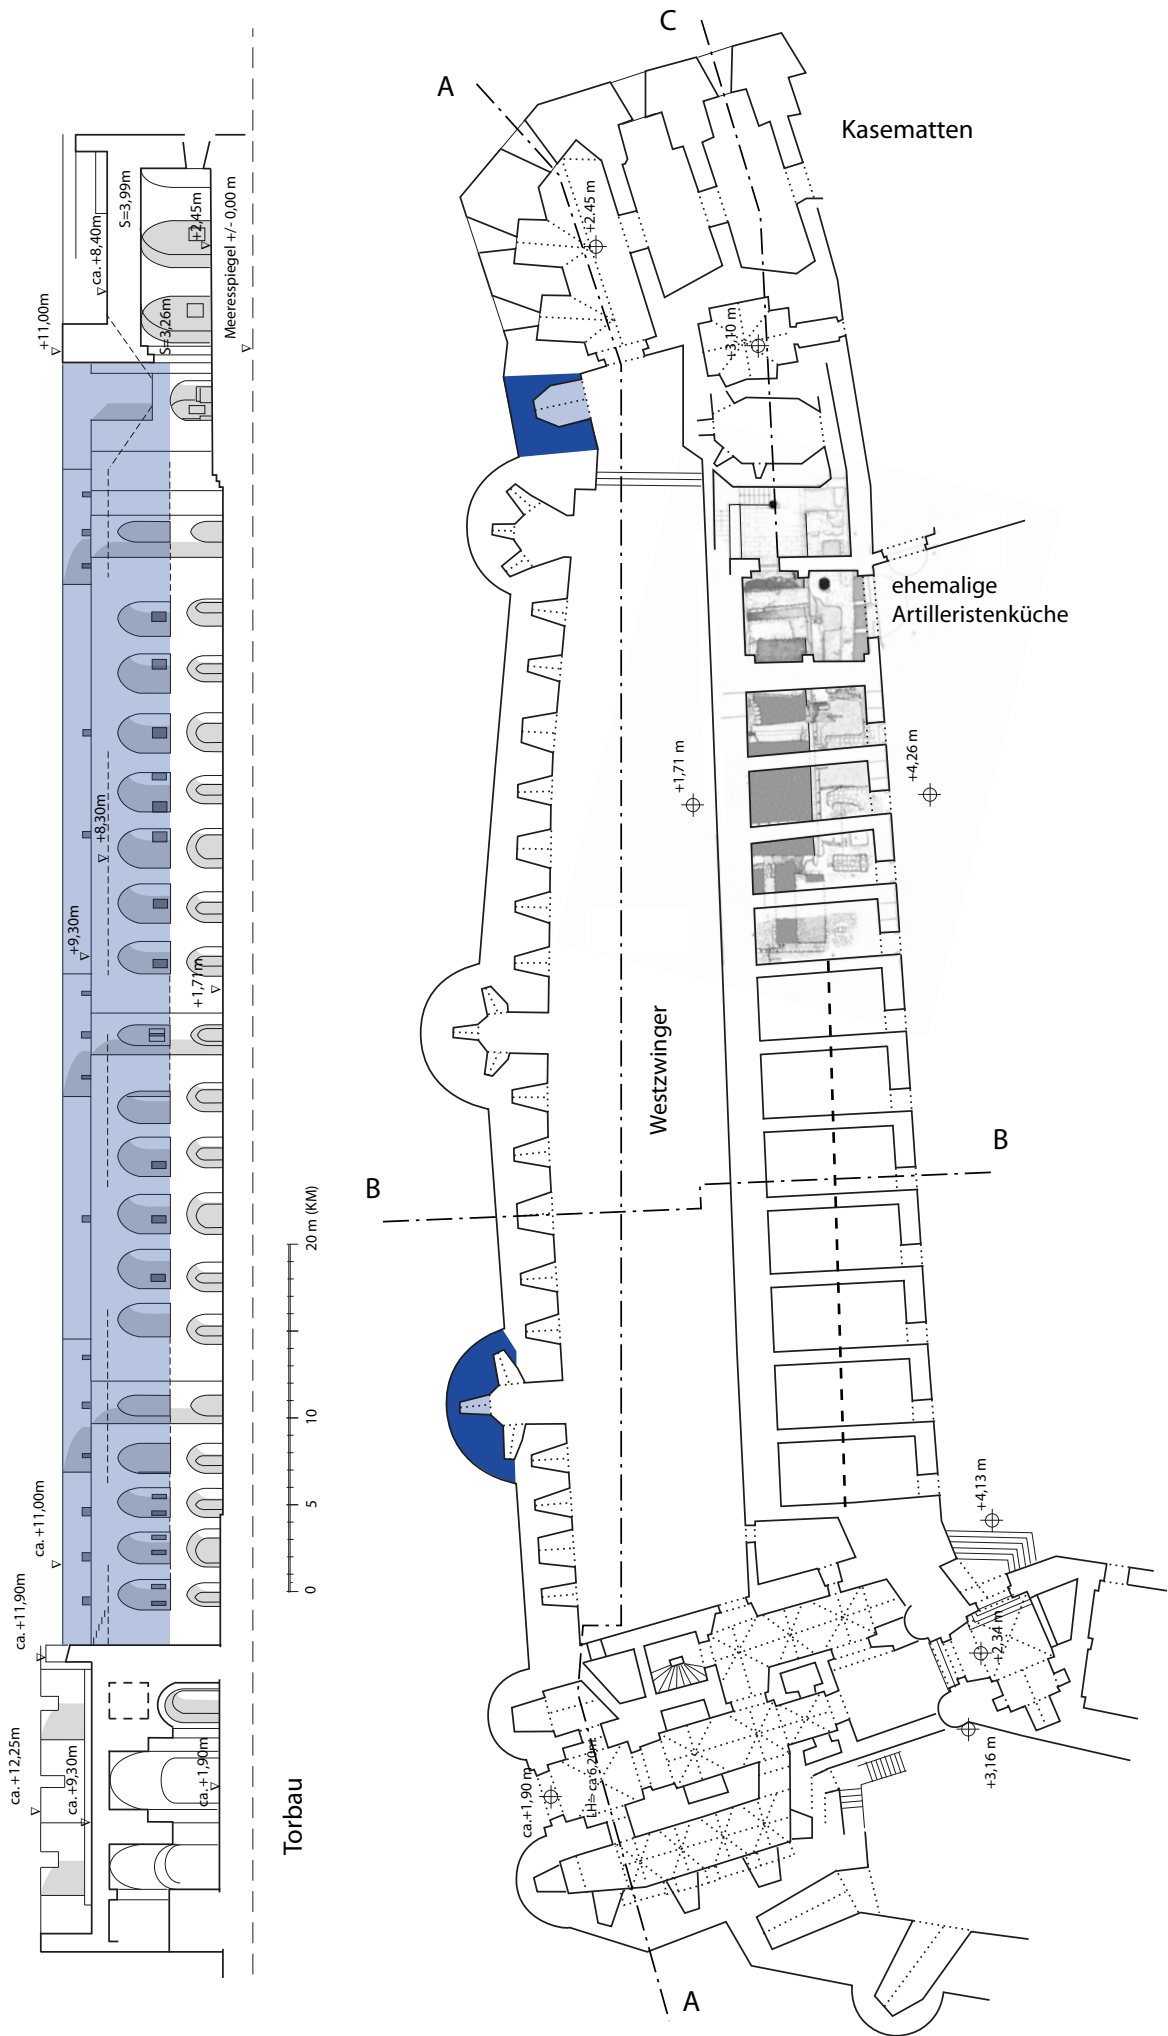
Die westliche Wehrmauer: Grundriss und Schnitt A-A.
